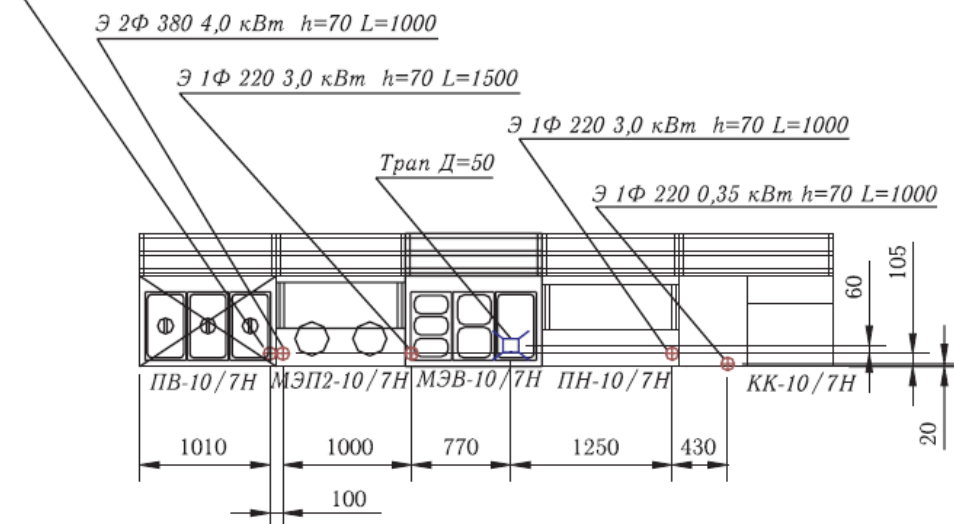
Габаритные размеры и схема подключения линий раздачи
